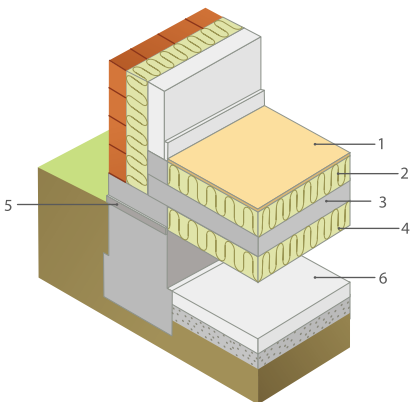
Дополнительное утепление перекрытия над подвалом:
